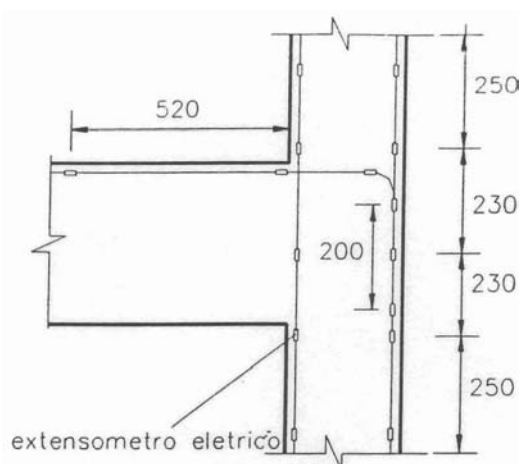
Instrumentação do pórtico ensaiado
